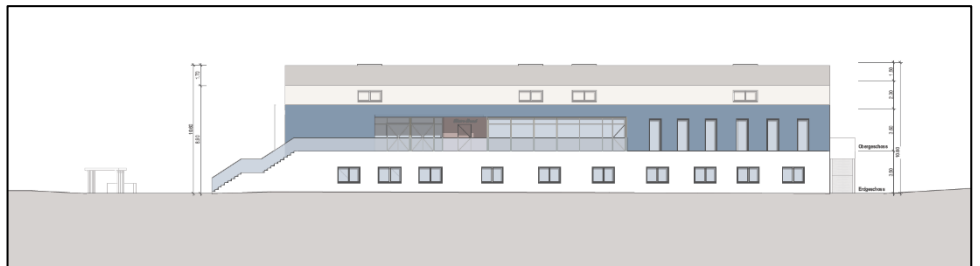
Südfassade Projektstudie Sporthalle Grund vom 11. Mai 2020, Gebau AG
